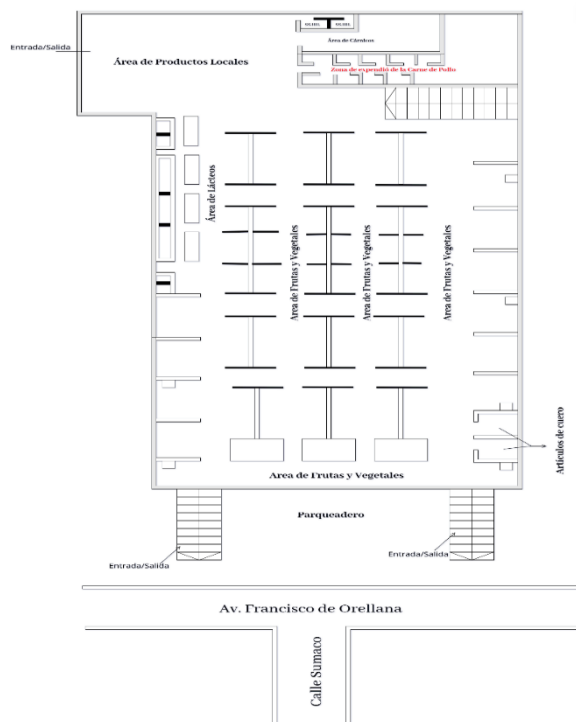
| Plano planta baja del Mercado Centro Agrícola de Pastaza
